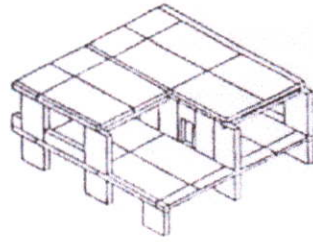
ระบบโครงสร้างแบบ Long - wall
